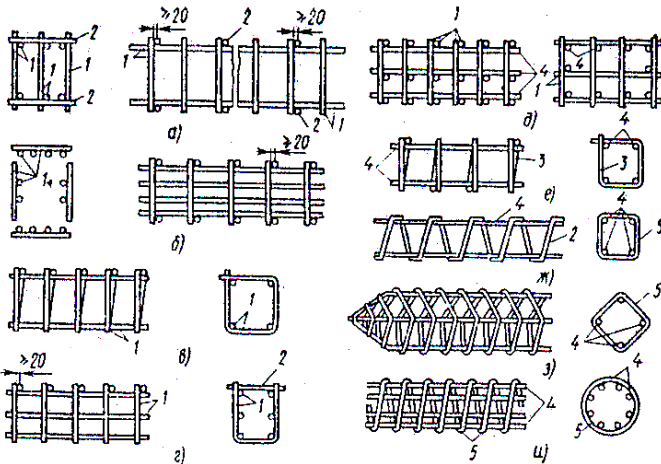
Примеры устройства пространственных арматурных каркасов: а – из плоских сеток, соединенных стержнями; б – объединением сеток сваркой; в, г – из гнутых сеток; д – из плоских сеток и продольных стержней; е – из продольных стержней и хомутов; ж, з, и – из продольных стержней с поперечной спиральной арматурой; 1 – сетки; 2 – соединительные стержни; 3 – хомуты; 4 – стержни продольной арматуры; 5 – поперечная спиральная арматура
